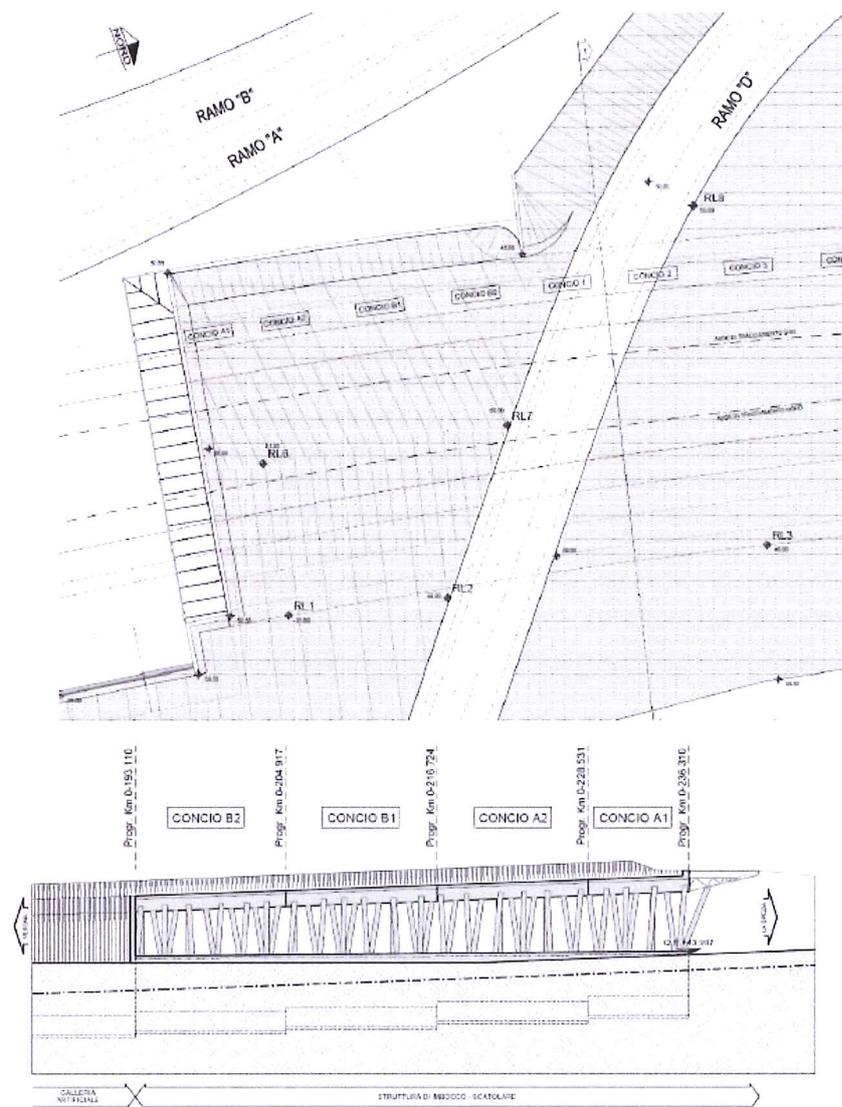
Struttura di imbocco – tratto finestrato – configurazione Progetto Esecutivo
